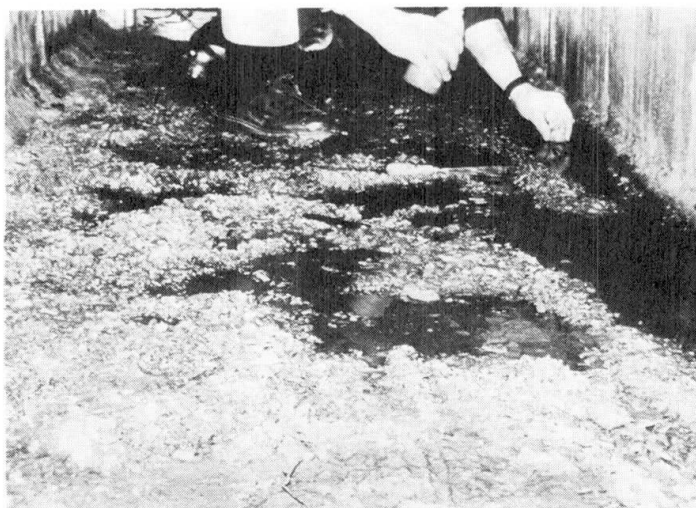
Dégât de gel au plancher de caissons inaccessibles
